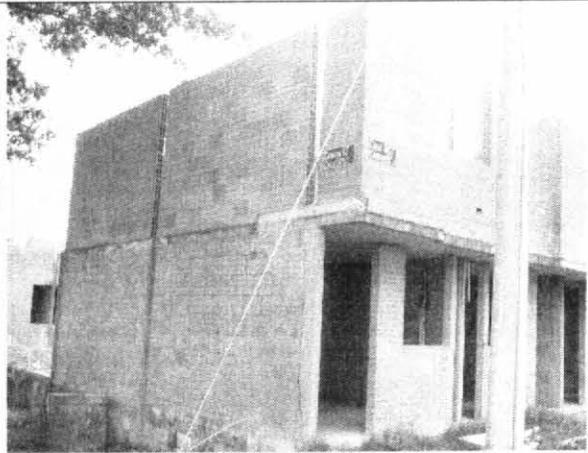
Muros externos del primer piso ya construidos y los de segundo piso sin confinar.
